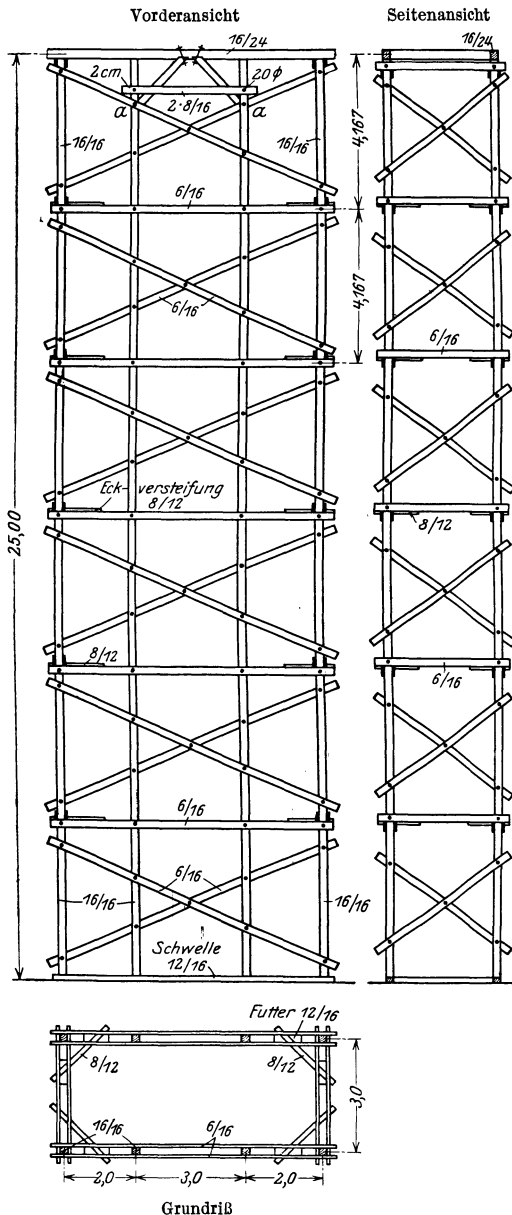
Gerüst zum Umbau des Gloriapalastes in Berlin.
